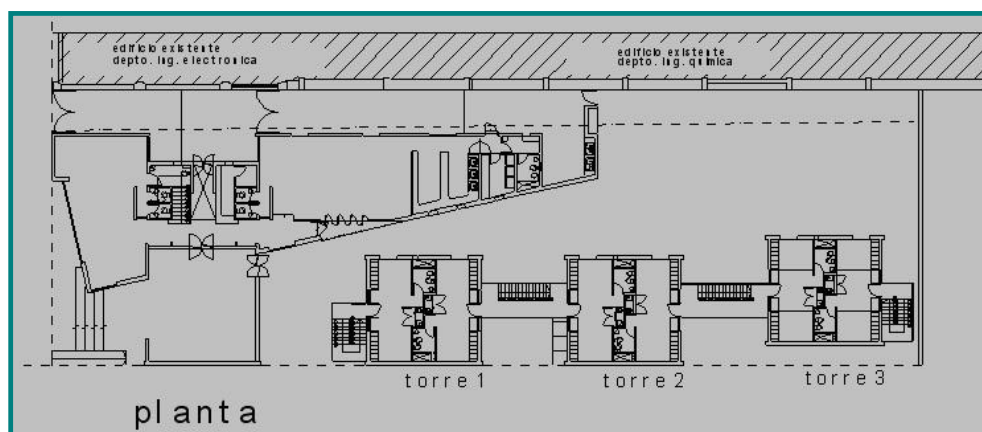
Planimetría general del complejo a nivel de Planta Baja.
